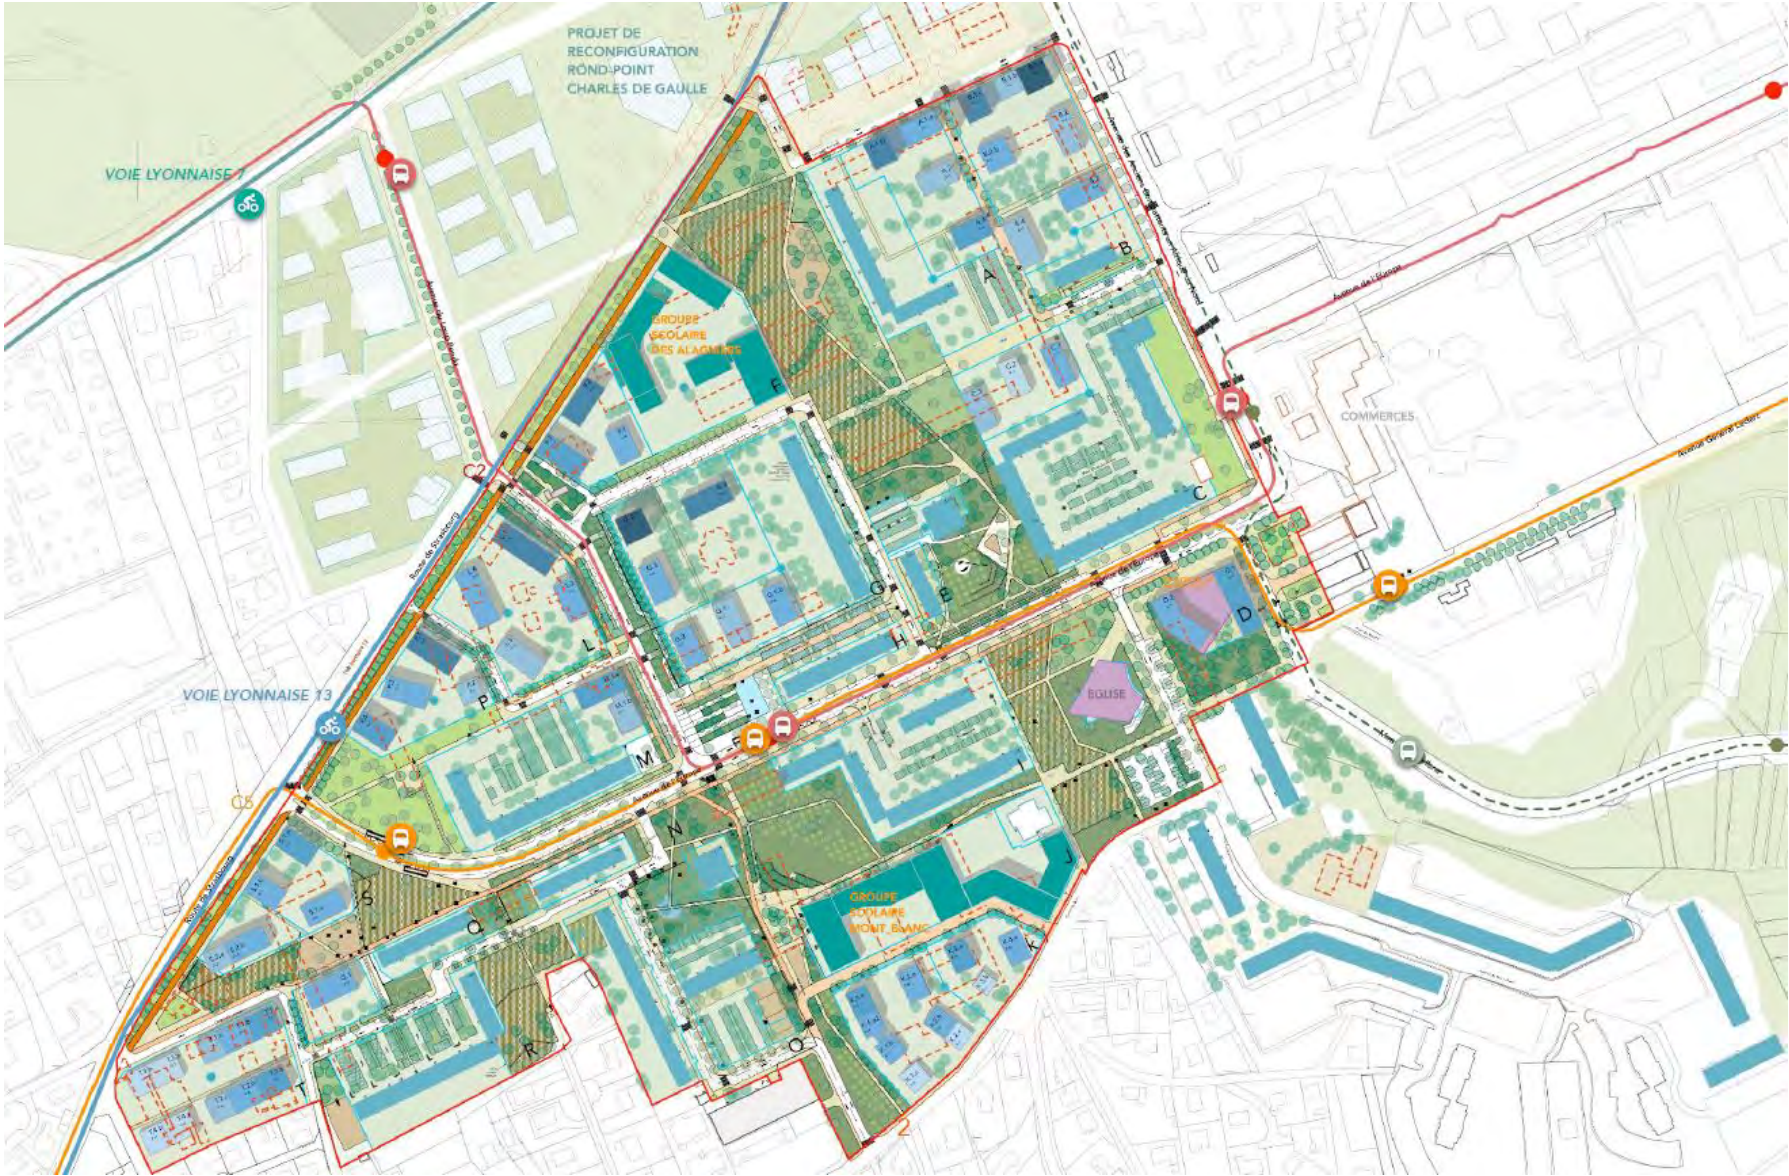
Plan de composition du projet final de la ZAC Alagniers (Source Plan de Composition Mai 2024)
